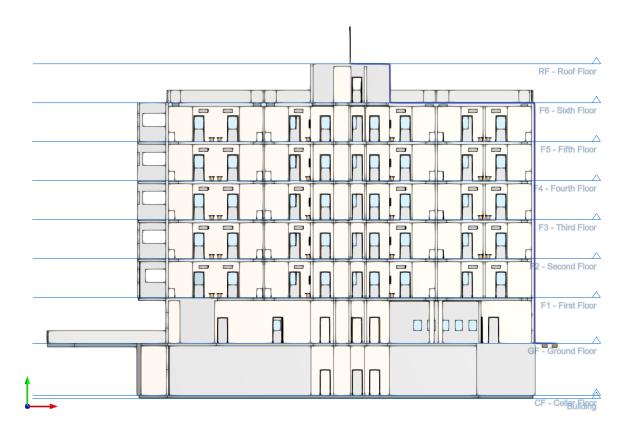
Vista de alzado y su referencia en una vista de plano de planta (Open BIM Lightning)
